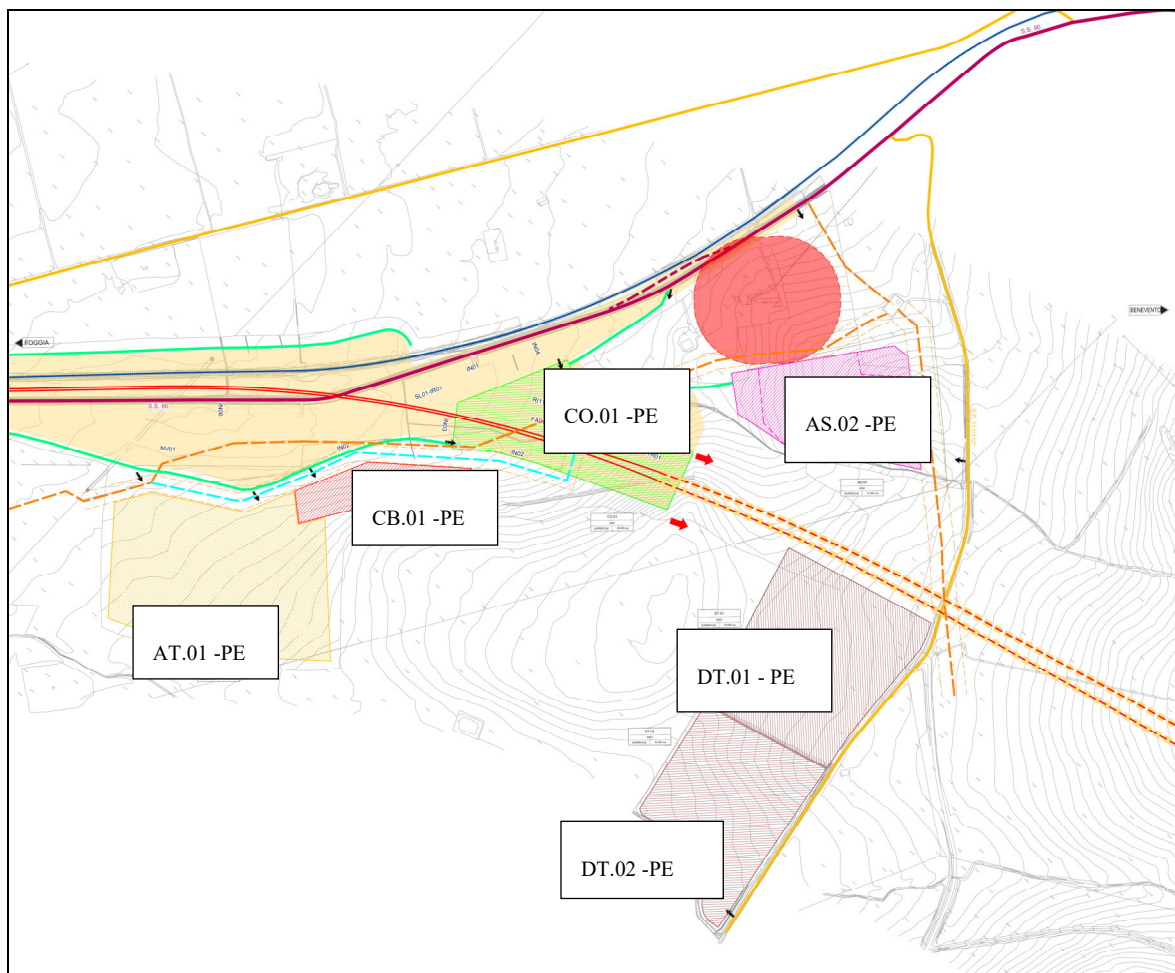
Lay-out complessivo cantieri lato Bari – Progetto esecutivo
